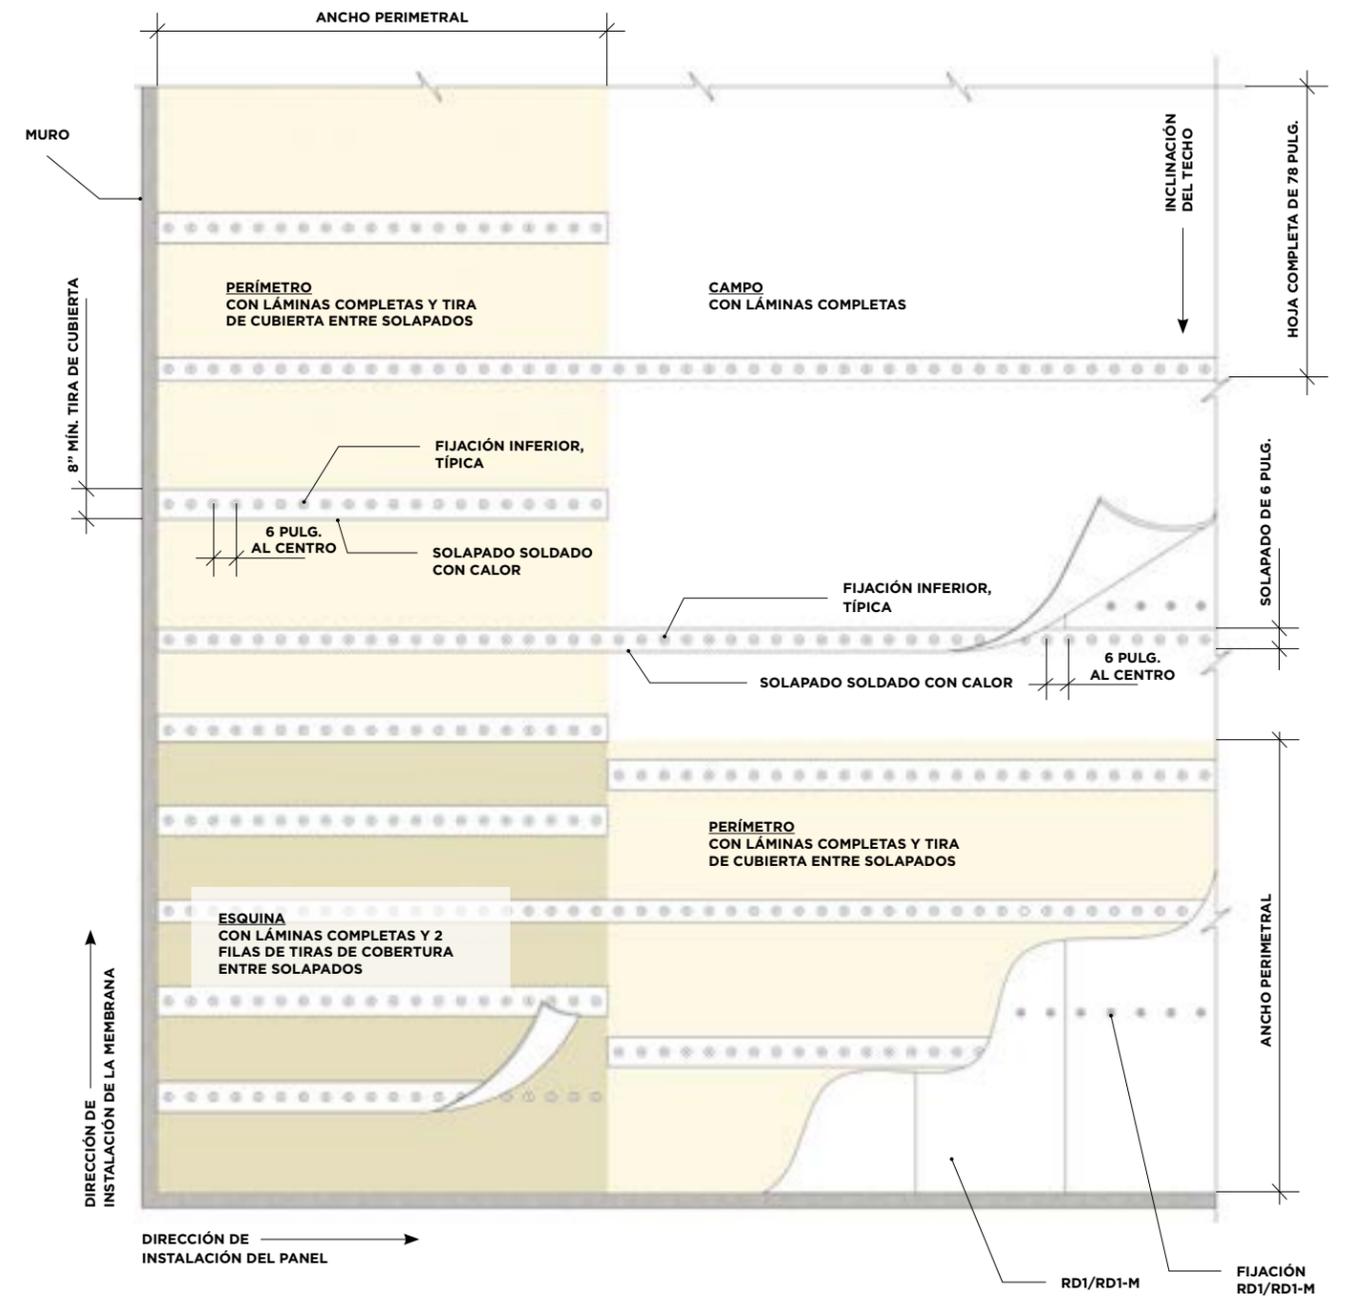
MEMBRANA DE TPO/PVC FIJADA MECÁNICAMENTE ONEDEK (USANDO TIRAS DE CUBIERTA) (VISTA DE PLANTA)
